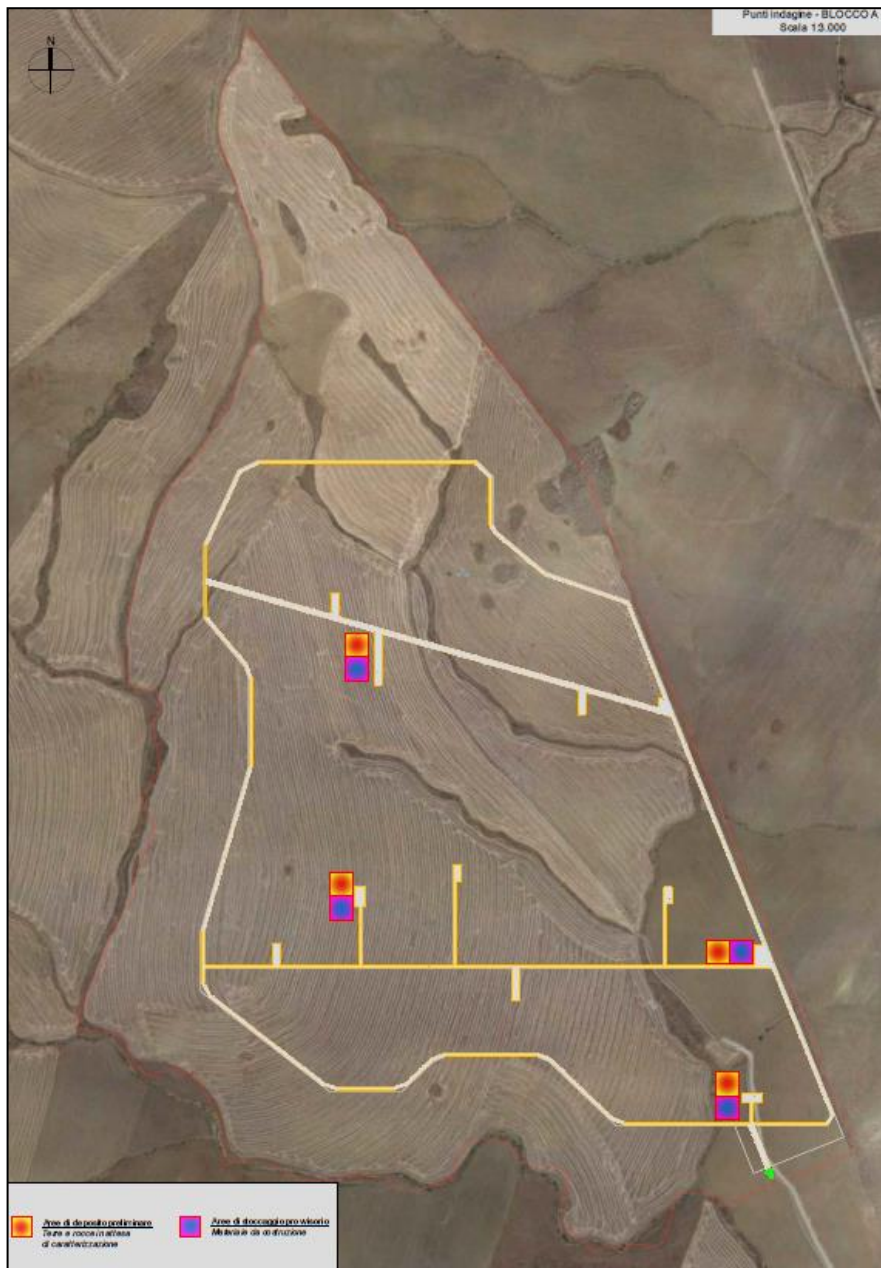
Planimetria aree di cantiere – BLOCCO A
